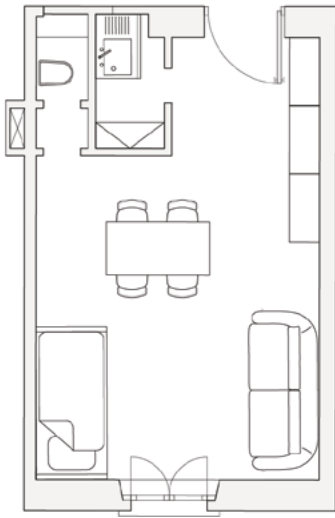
Piano primo di via Barrili 17, stato di fatto attuale
